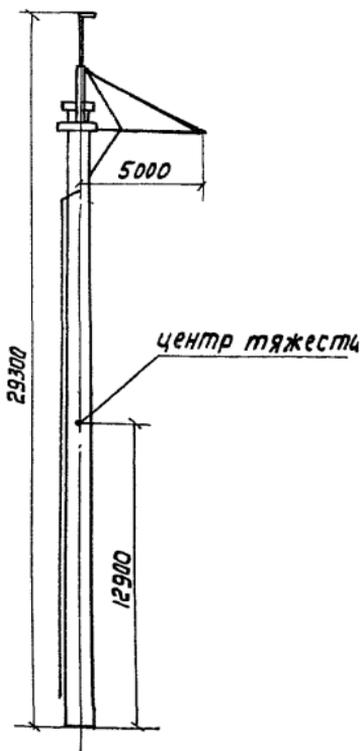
Монтажные элементы раздельной установки стоек опор
